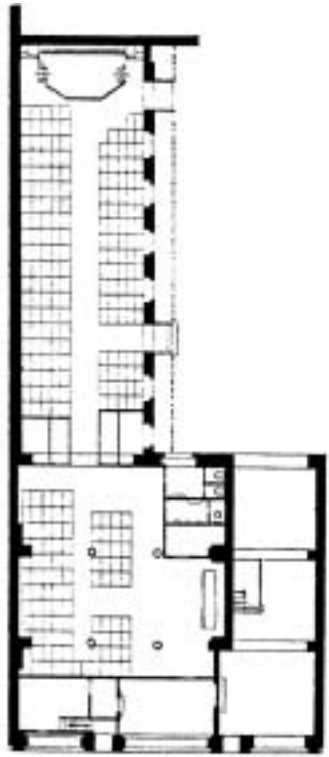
Grundriss eines Ladenkinos (nach 1905)
